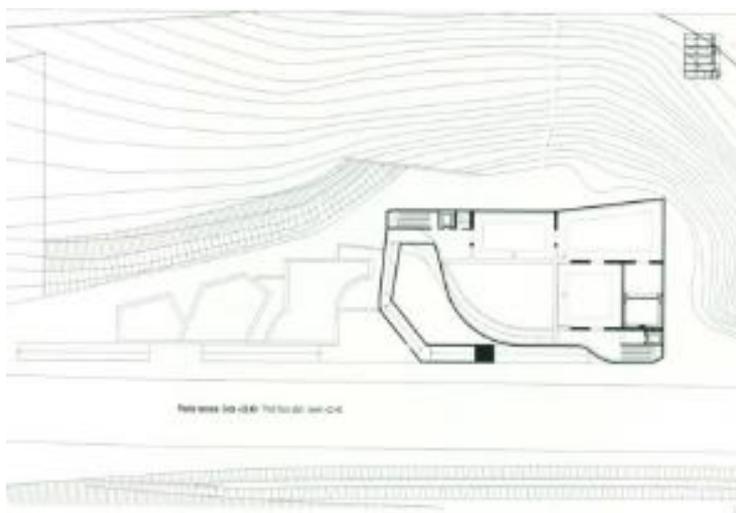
Planta baixa - terceiro pavimento – cota +22.40
